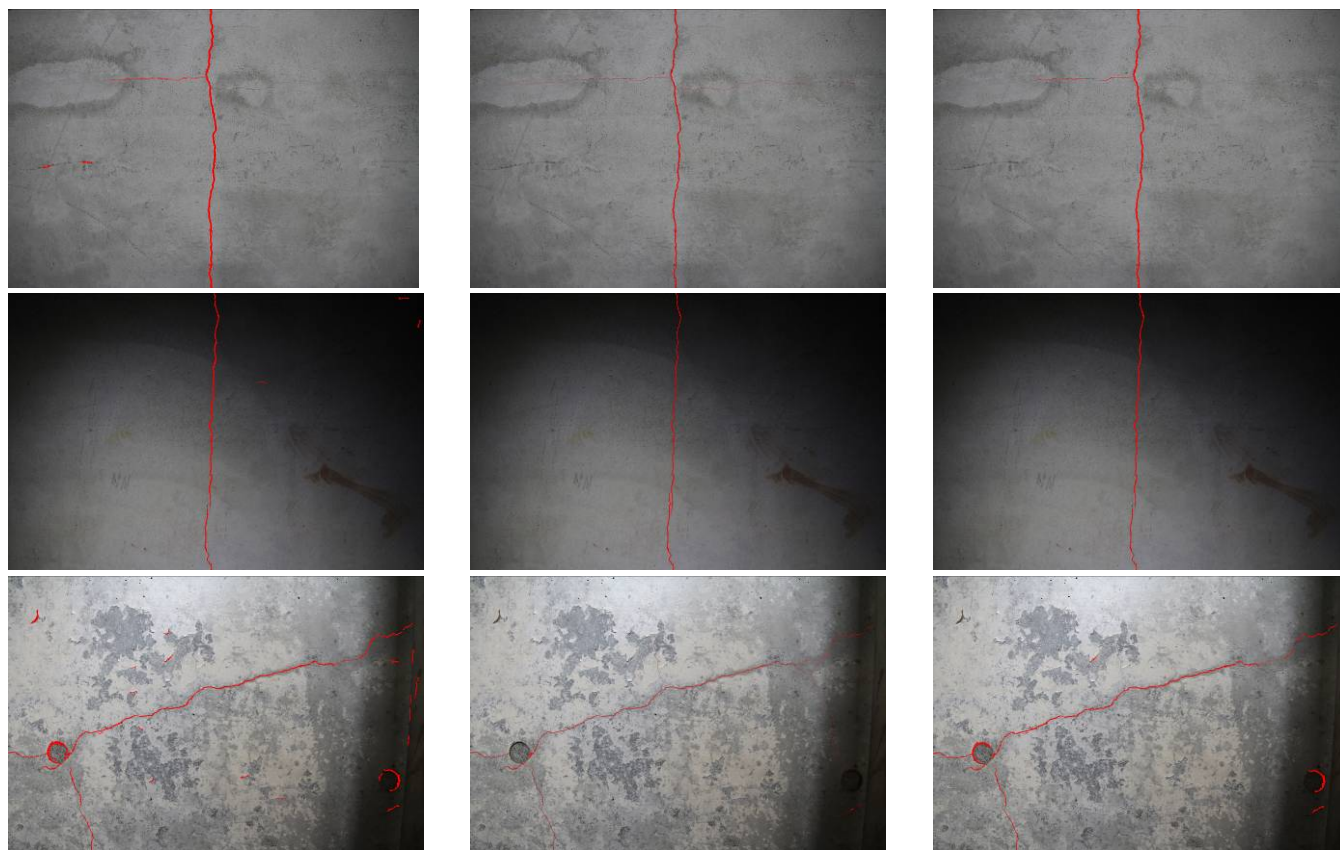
ひび割れ検出結果 (左列 : LightGBM, 中列 : 実際のひび割れ位置, 右列 : Random Forest)
